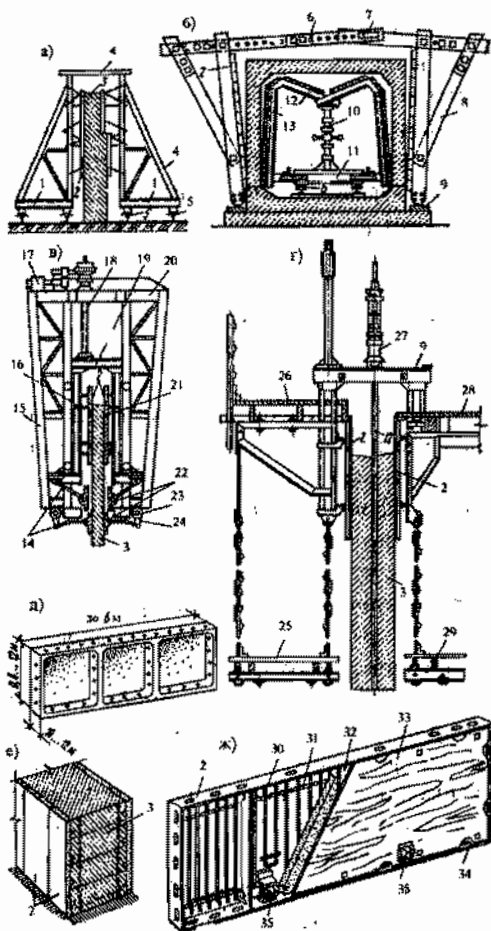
Виды катучей горизонтально- и вертикально-скользящей опалубки (а, б, в, г), несъемной (д, е) и греющей опалубки (ж): 1 - тележки; 2 - щиты опалубки; 3 - бестоцируемая конструкция; 4 - каркас; 5 - катки; 6 - поперечина; 7 - отверстия для болтов; 8 - рама наружной опалубки; 9 - опорная доска; 10 - стойка с домкратом; 11 - рама; 12, 13 - верхние и боковые щиты; 14 - рычаги; 15 - опорная наружная рама; 16 - подъемная внутренняя рама; 17 - привод винтового подъема; 18 - винт; 19, 20 - ригели подъемной и опорной рамы; 21 - кружала; 22 - опорные пластины; 23 - коробка; 24 - напорные рукава; 25 - подвесные леса; 26 - козырек; 27 - гидравлический домкрат; 28 - настил рабочей площадки; 29 - внутренние подвесные подмости; 30 - греющий кабель; 31 - крепление кабеля; 32 - утеплитель; 33 - защитный кожух; 34 - вырез для крепления щитов; 35 - вилочный разъем щитов
